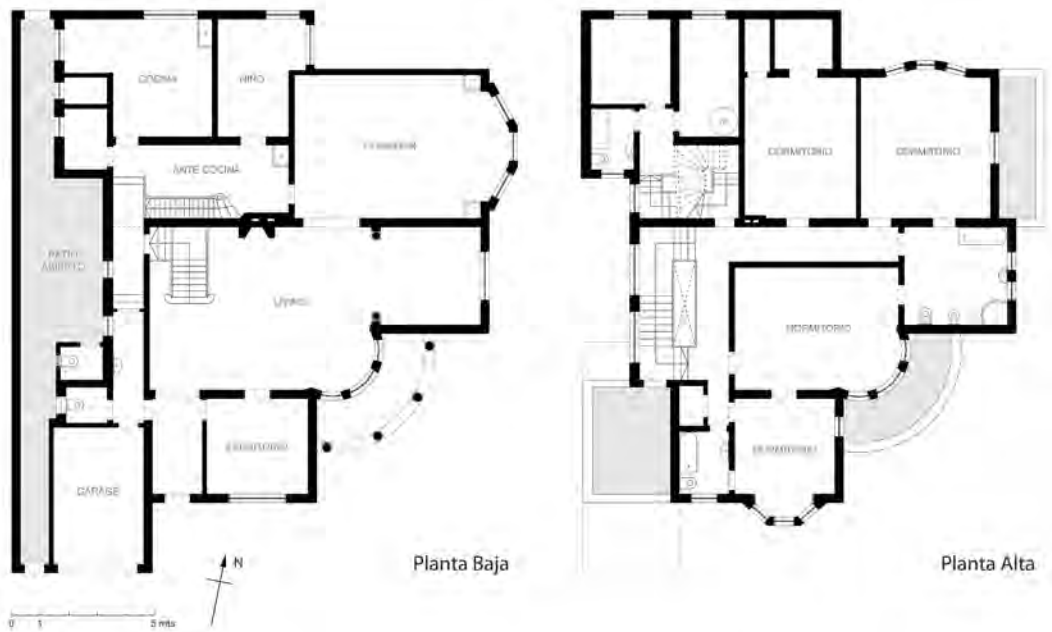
Plantas de la casa Schenström en su distribución original. Fuente: elaboración del autor a partir de planos relevados en el Archivo de Planos Domiciliarios de AySA.
